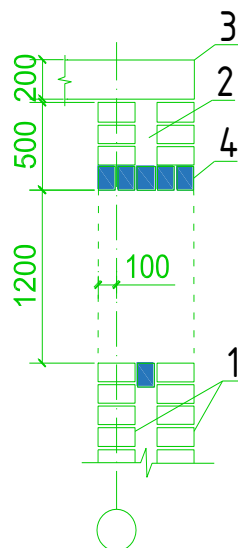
Узел наружной стены: 1 – керамзитобетонные блоки 400х200х100 мм средней плотностью 1000 кг/м<sup>3</sup>; 2 – утеплитель пенополистирол ПСБ-С35 объемной плотностью 35 кг/м<sup>3</sup>, толщиной 100 мм; 3 – плита перекрытия; 4 – перемычки сборные железобетонные 8ПБ 19-3 размером 1940х120х90 мм.
